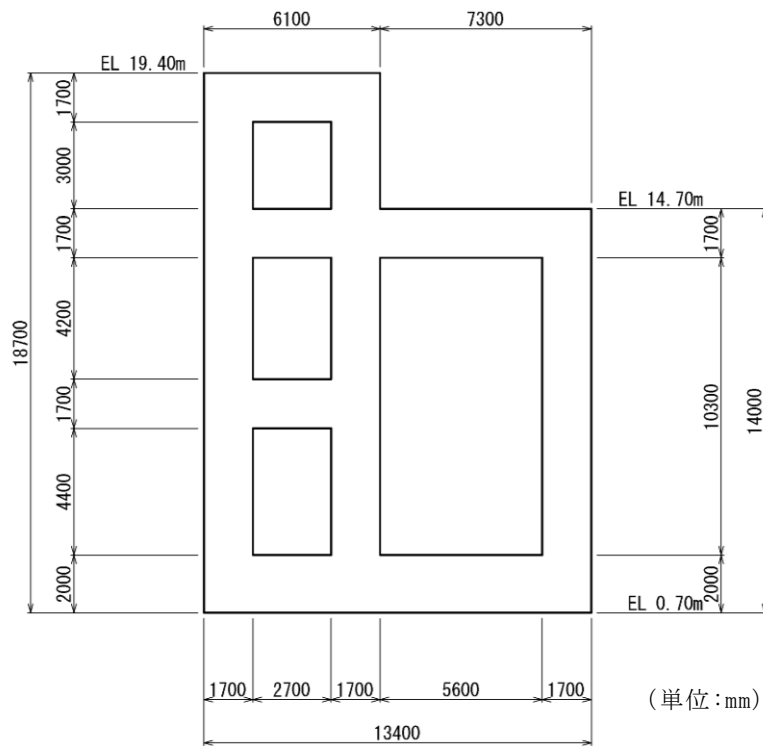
第 1 ベントフィルタ格納槽 断面図 (A-A 断面)
